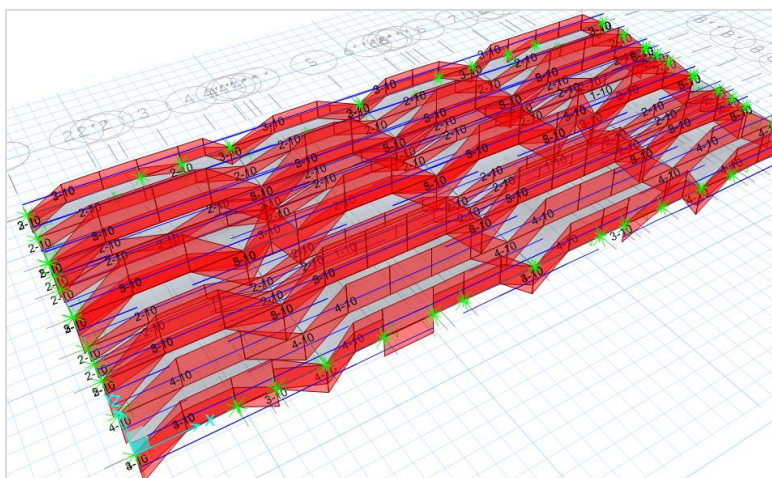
Colocación de Acero de Refuerzo. SAFE
